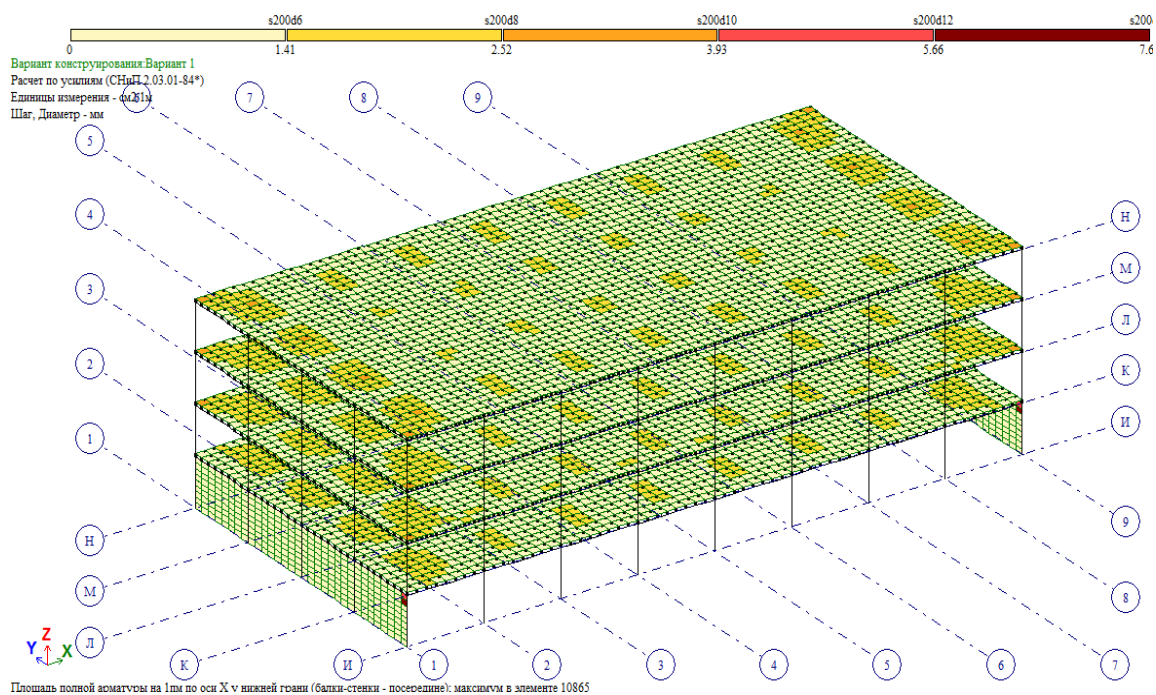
Нижнее армирование плит по оси ОХ. Армирование стенок нулевого этажа
